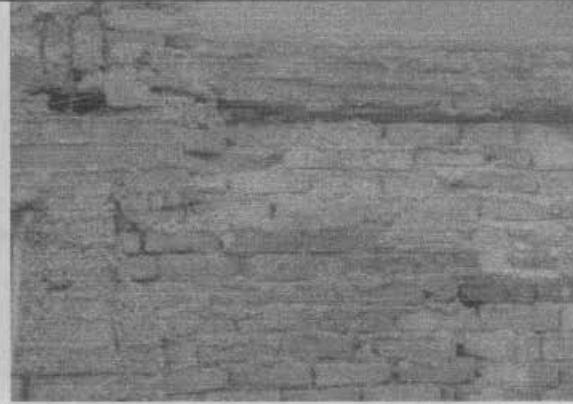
Unión columna-placa, sin concreto. Deflexiones en placa de primer piso.
